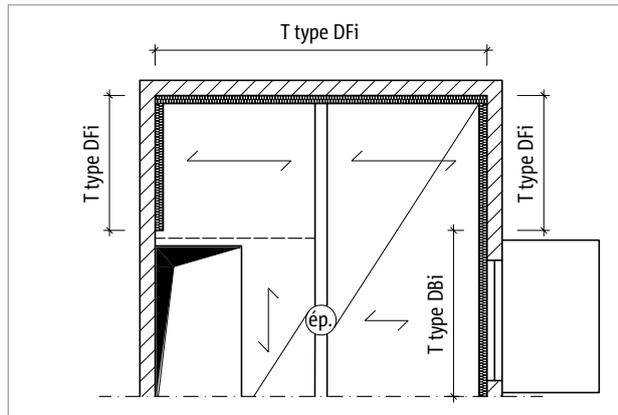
Schöck Rutherma® T type DBi : vue en plan
